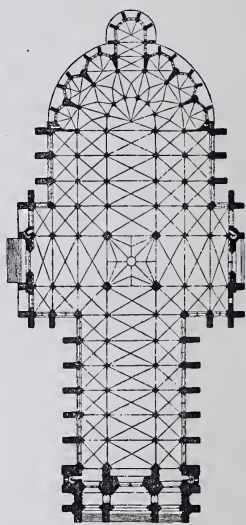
Grundriss der Kathedrale zu Amiens.
